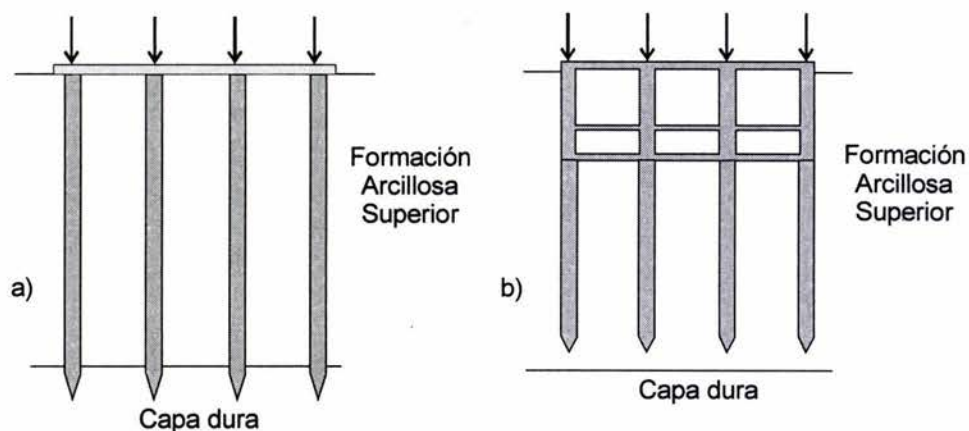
Pilotes de punta (a) y fricción (b)
